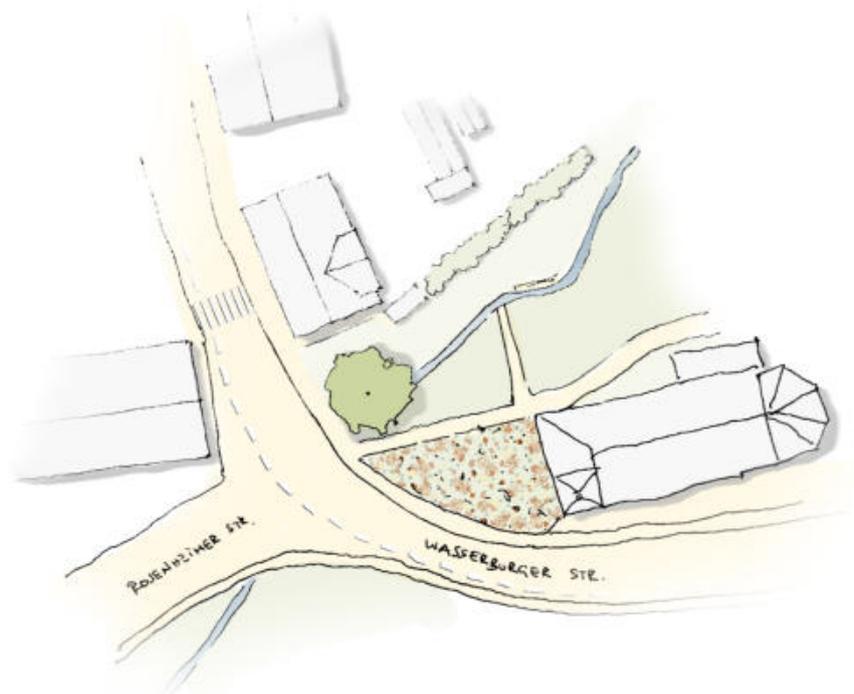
Lageplanskizze - Umgestaltungsbeispiel | Wasserburger Straße
